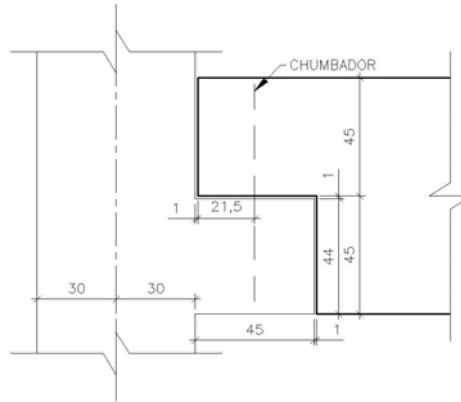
Geometria do consolo para apoio da viga VR01 (unidades em cm).
